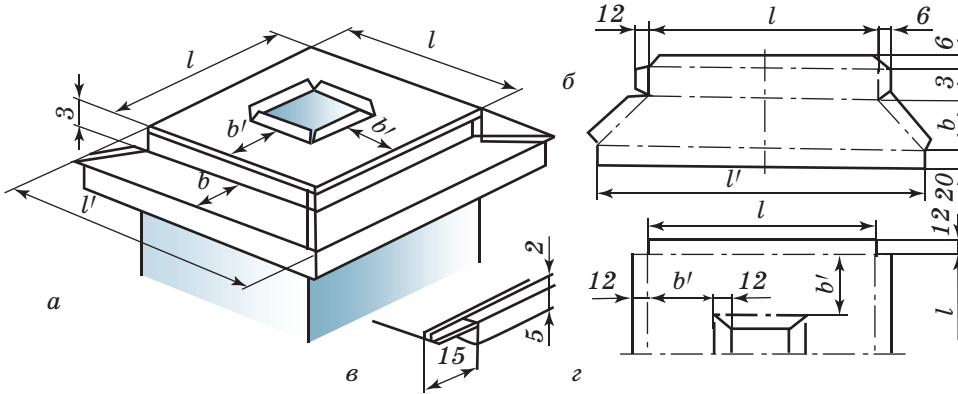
Виготовлення ковпака димовідвідної труби:
